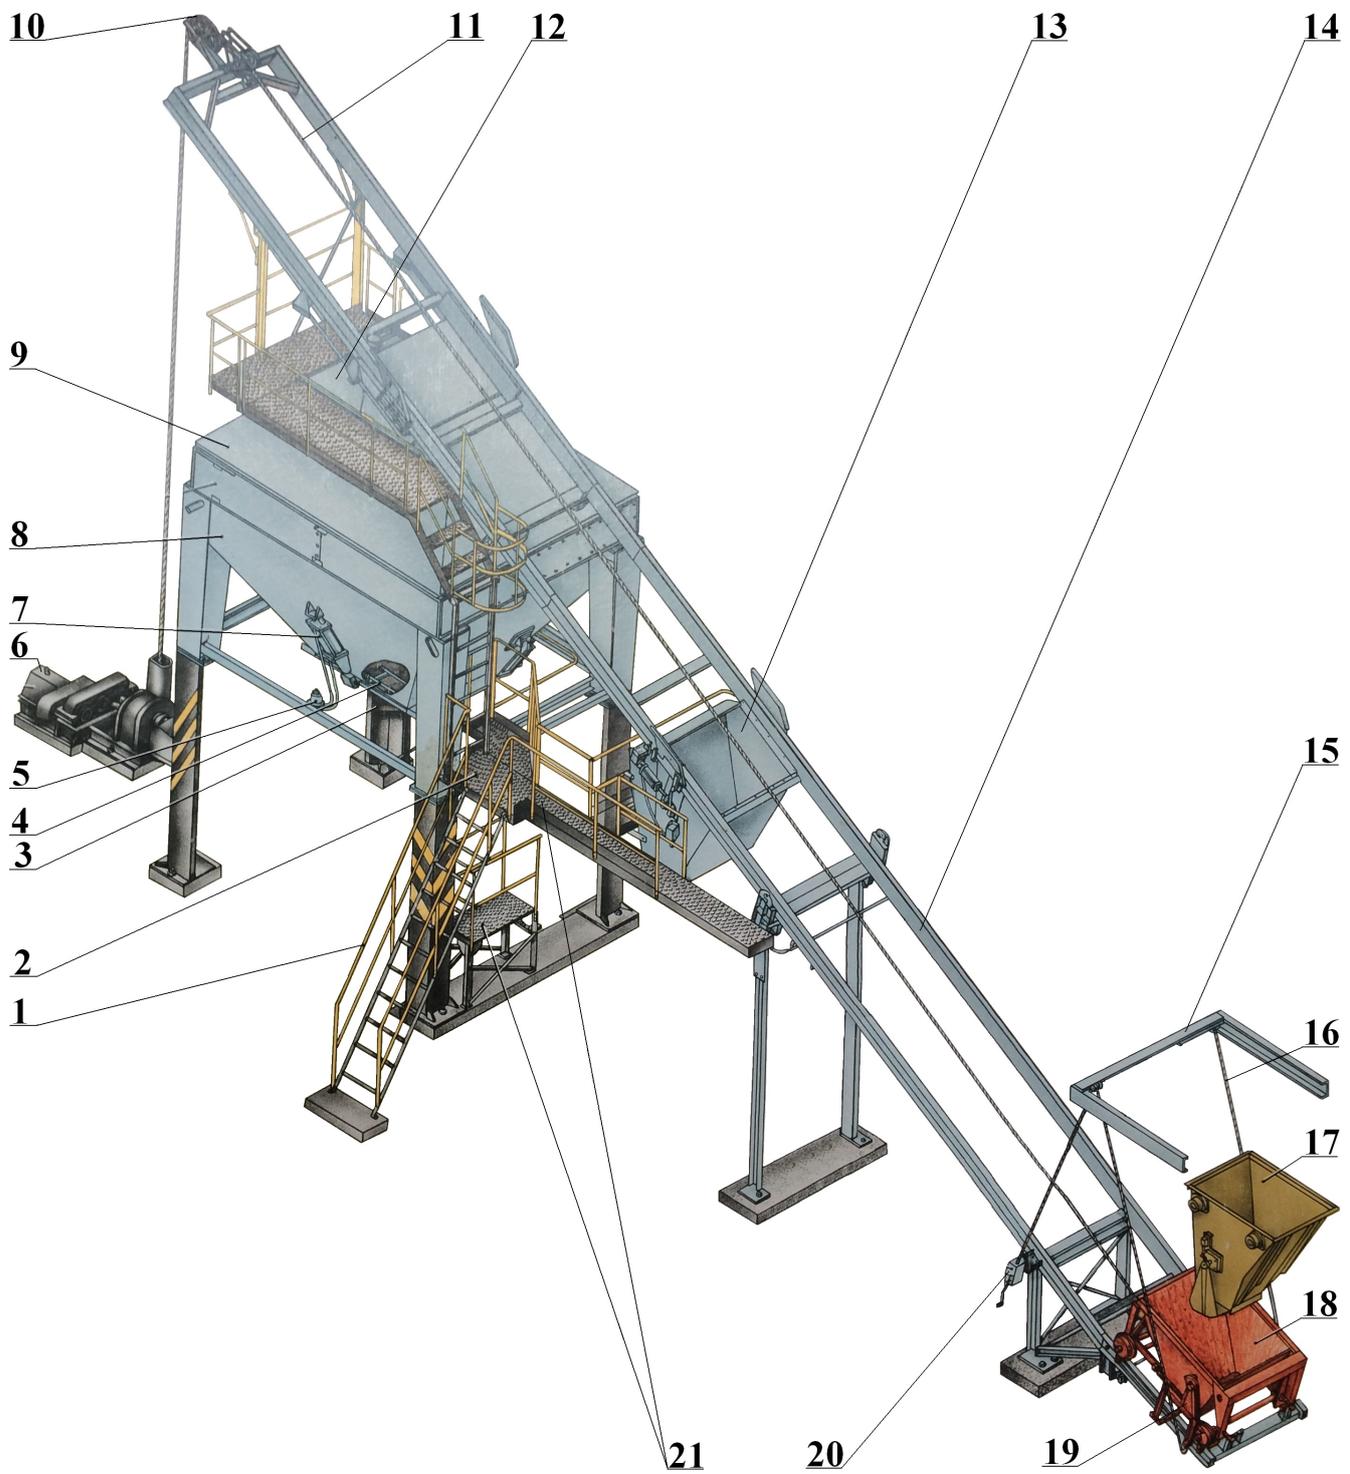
Внешний вид и устройство накопительного термос-бункера со скиповым подъёмником: 1 – лестница; 2 – осмотровая площадка; 3 – затвор; 4 – трубчатый электронагреватель; 5 – управление затвором; 6, 20 – лебёдка; 7 – механизм открывания затвора; 8 – кожух термос-бункера; 9 – накопительный термос-бункер; 10 – шкив подъёмного механизма; 11 – трос подъёмного механизма; 12 – загрузочная горловина термос-бункера; 13 – бункер загрузки автосамосвала; 14 – подъёмная эстакада; 15 – рама смесителя; 16 – трос скипа; 17 – загрузочный бункер смесителя; 18 – тележка скипа; 19 – разгрузочный механизм; 21 – площадки контроля
